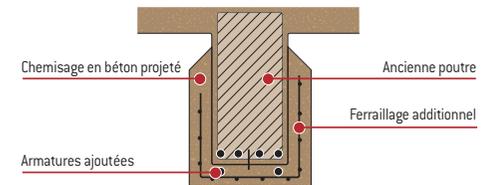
Exemple de renforcement d'une poutre par béton projeté (coupe transversale)
